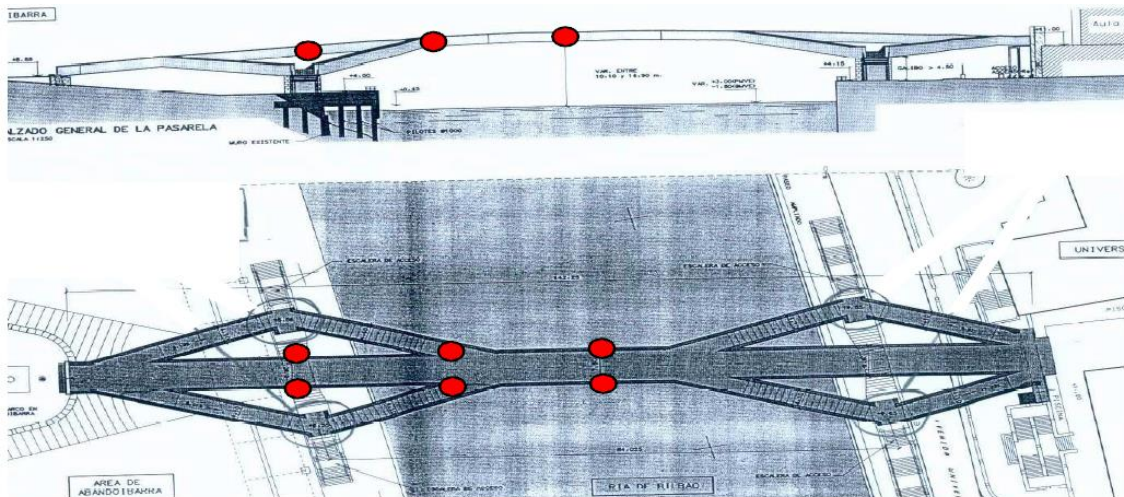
Planos lateral y en planta de la pasarela de Bilbao.
